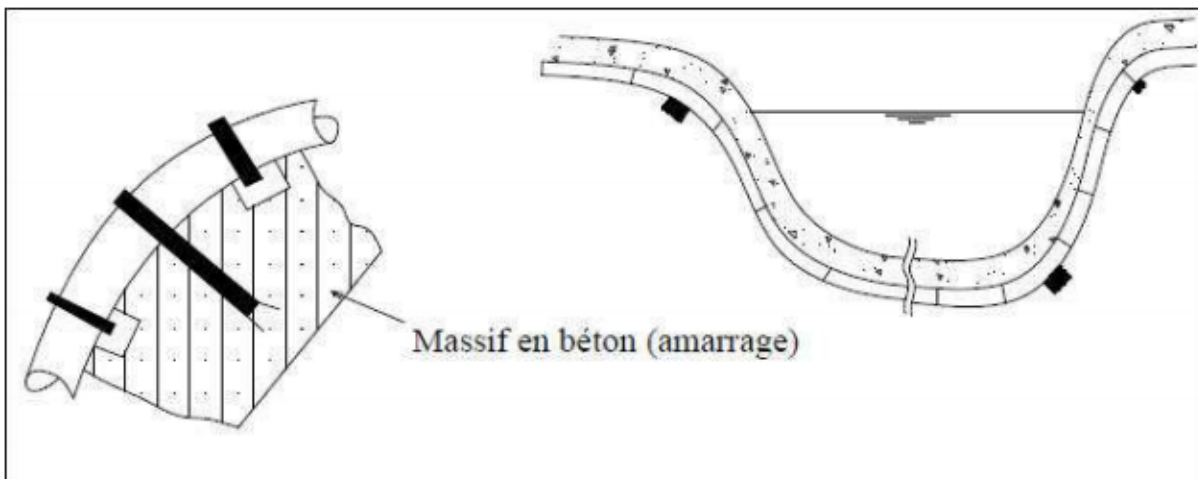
la traversée d'une rivière ou oued sans un pont-route (B.Salah)
